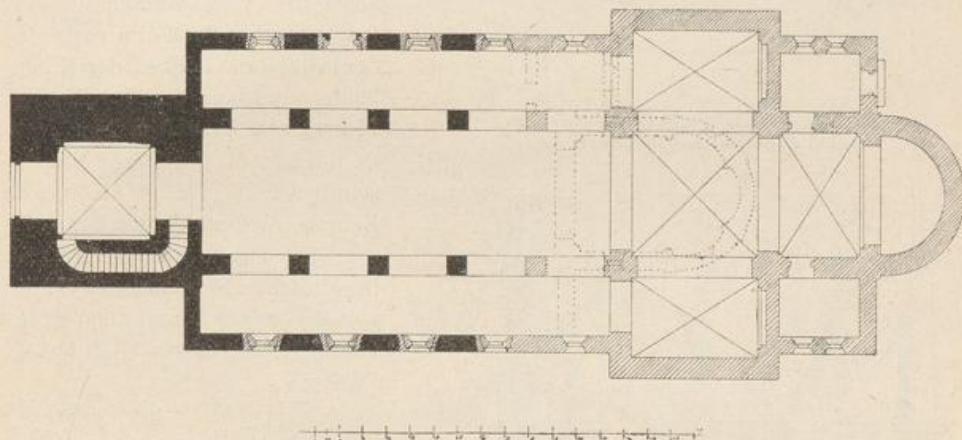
Odenthal Grundriss der katholischen Pfarrkirche nach der Erweiterung.
